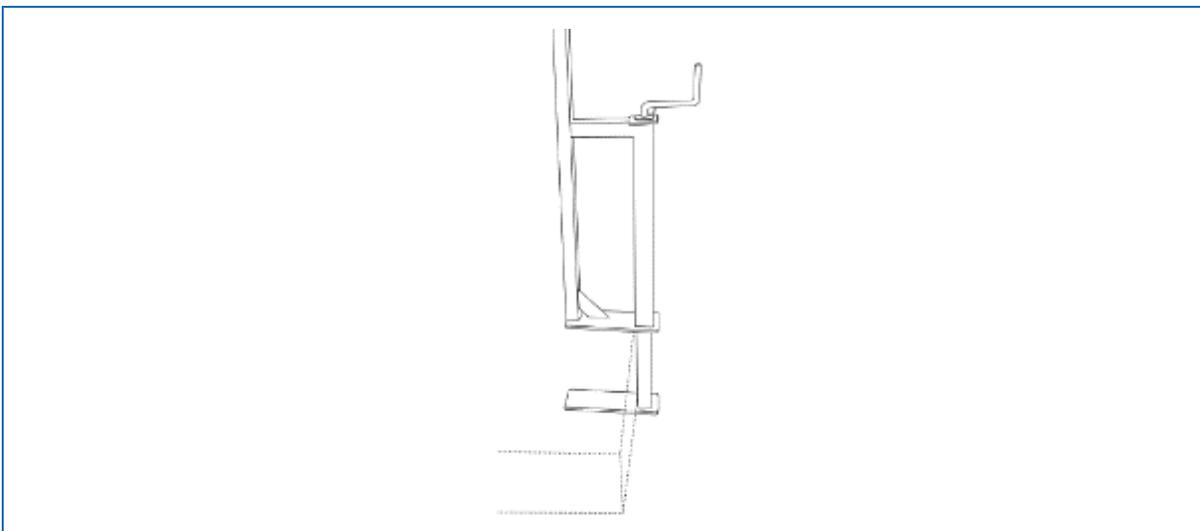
Esquema perfil tipo abrazadera de apriete - Elaboración Propia
